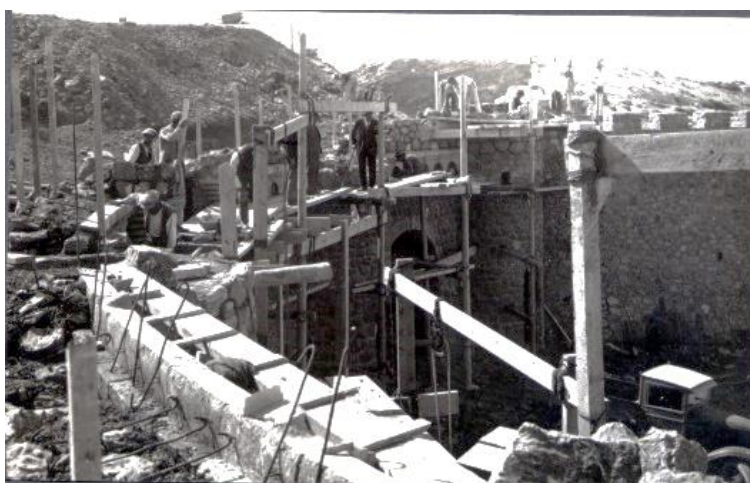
Construcción de la fachada principal de la batería de Castillitos. (Fuente: Lorenzo, 2019)
